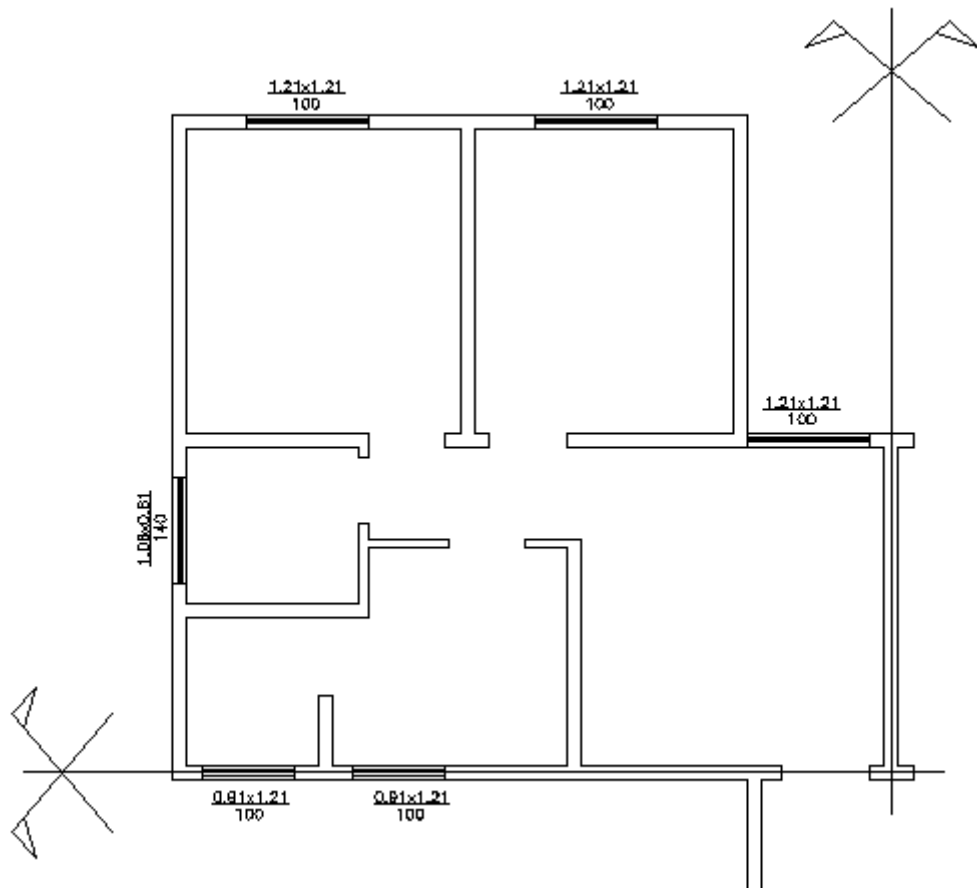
Detalhe da planta baixa edifício hipotético (dimensões em cm)
